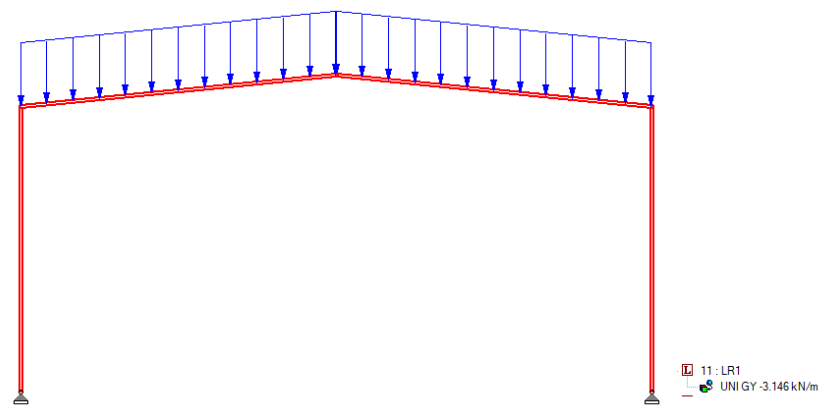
Sobrecarga de cubierta Lr1 del pórtico. Fuente: elaboración propia.
